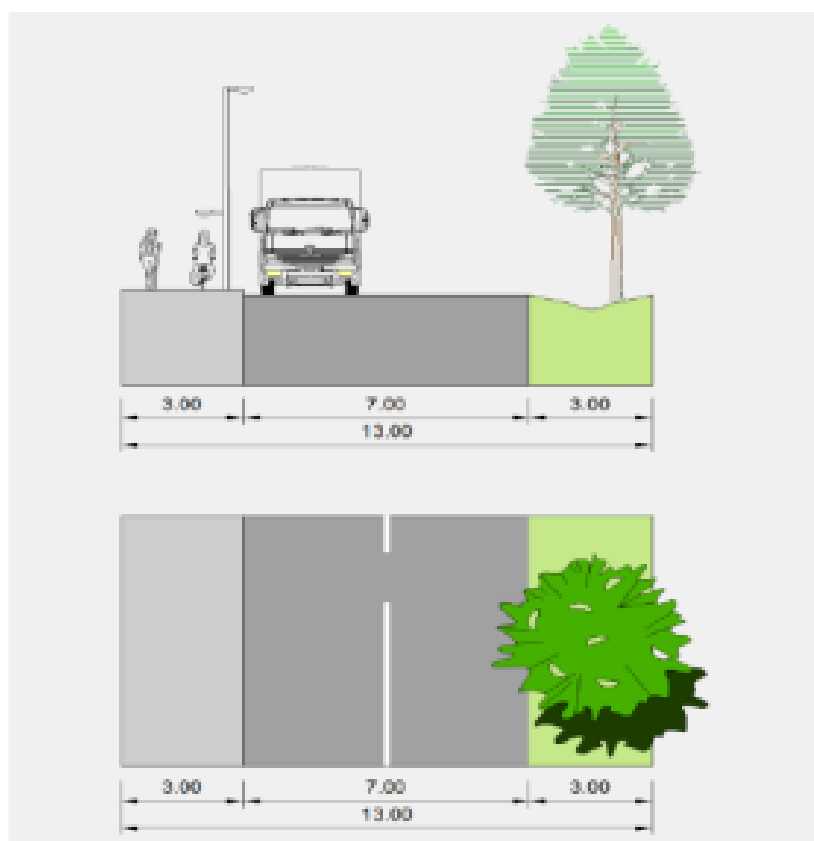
Schéma de principe des chaussées sur la zone d'activité
